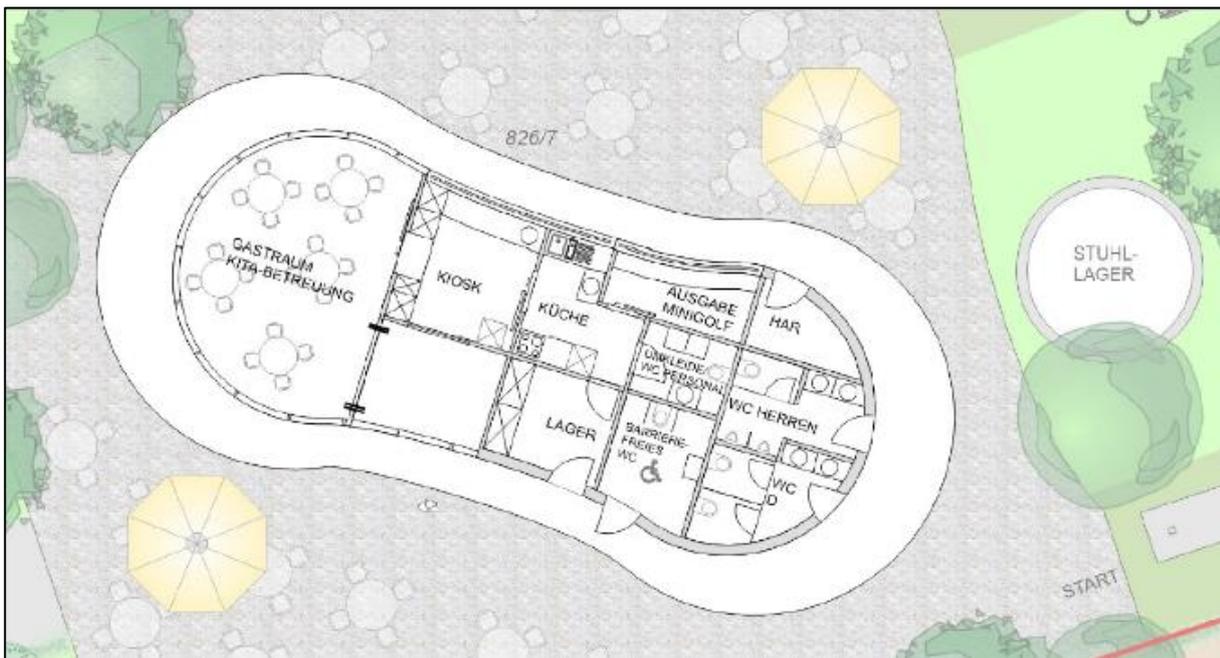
Grundriss des geplanten Pavillons (Arch.Gabrovsek)
